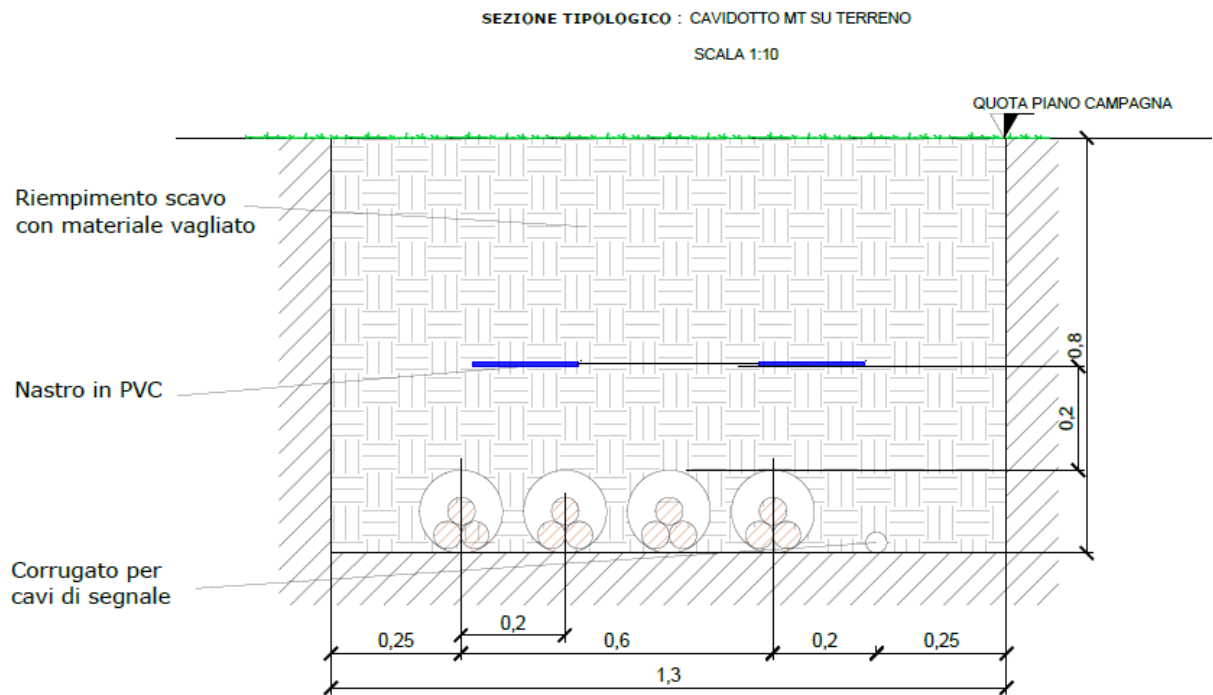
Sezione tipo posa con cavi direttamente interrati lungo terreno
